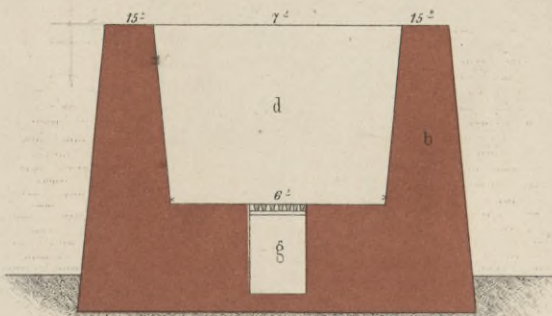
Grundriss über der Decke des Heerdes.
